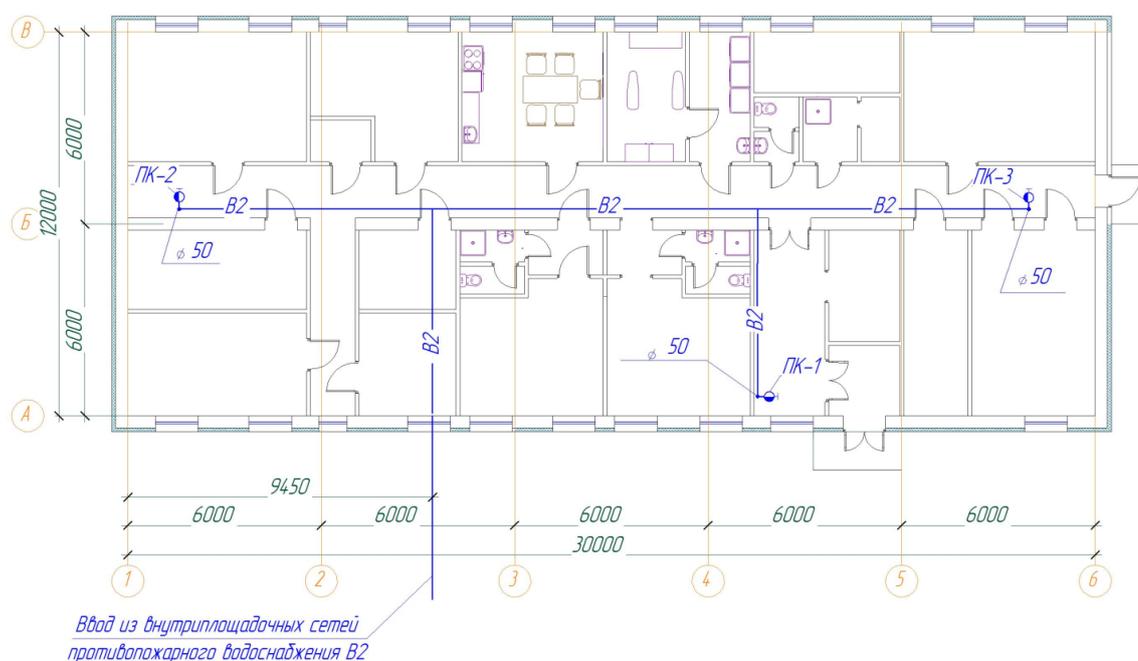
Схема размещения пожарных кранов и трубопроводов внутреннего противопожарного водоснабжения административного здания
